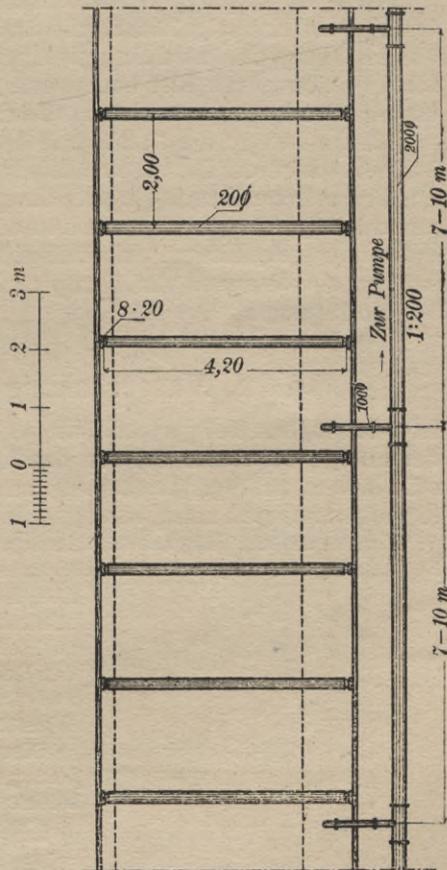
Absenken des Grundwassers in langgestreckter Baugrube.
